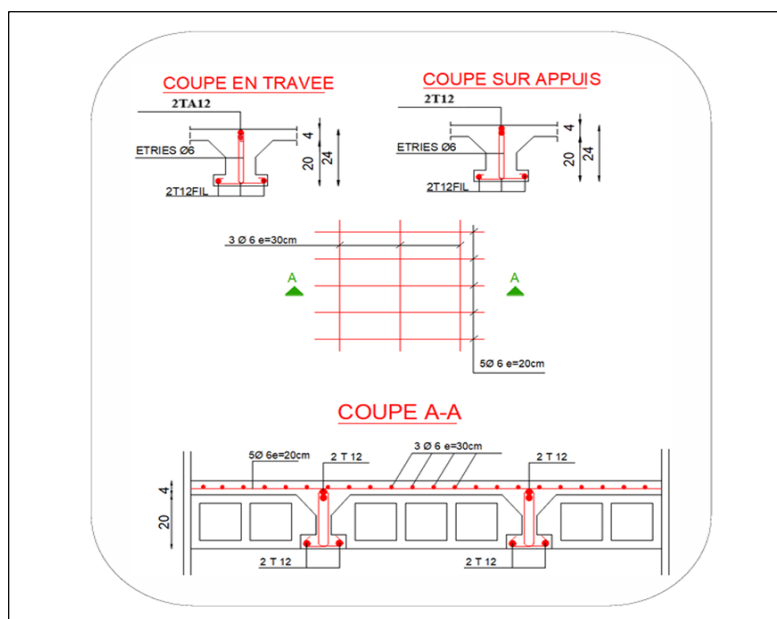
Schéma du ferrailage des poutrelles et dalle de compression.
